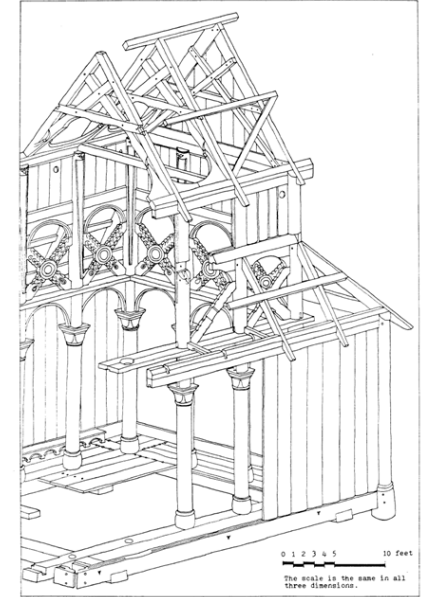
Esquema constructivo Stavkirke. Fuente: Norwegian wood: A case study of stave churches. Fuente: Harris (1982).
